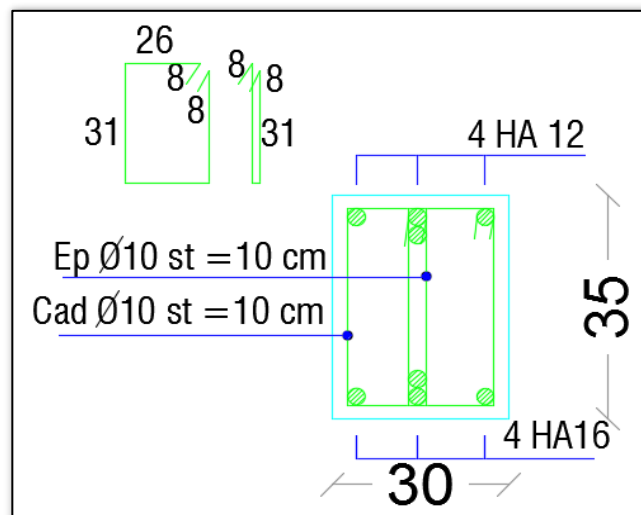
Schéma de ferrailage de la poutre selon l'EC2
